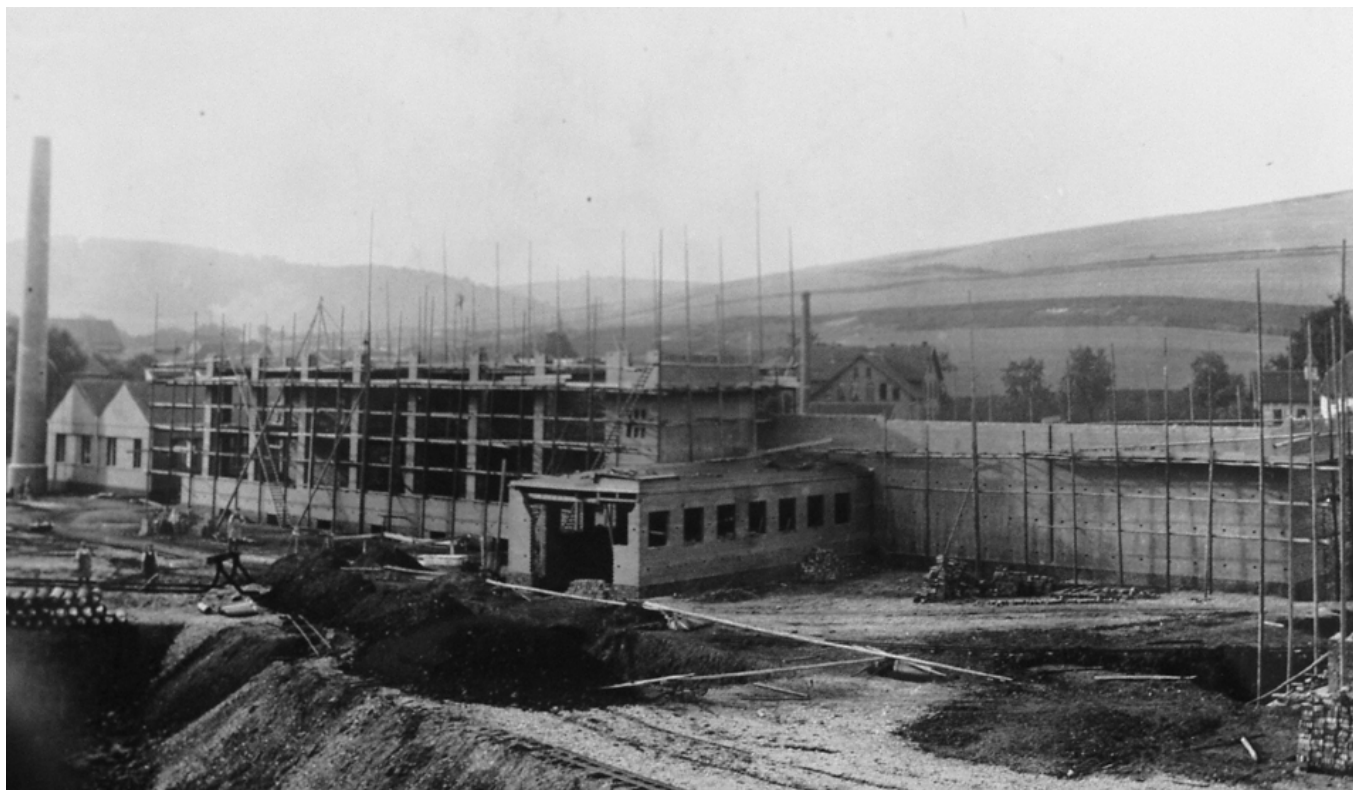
Fotografia da obra da Fagus, vista do lado da linha férrea, 1911-13/14 (in AB). Vê-se claramente a ausência de cofragens e a construção de paredes mestras em alvenaria fina de pedra.
